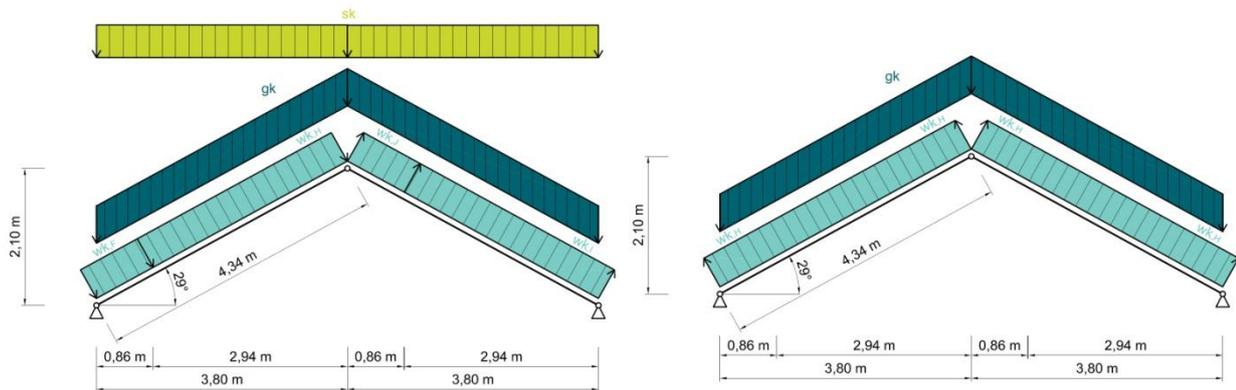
Belastungen Dachmodul: (links: Lastfall I, rechts: Lastfall II)
